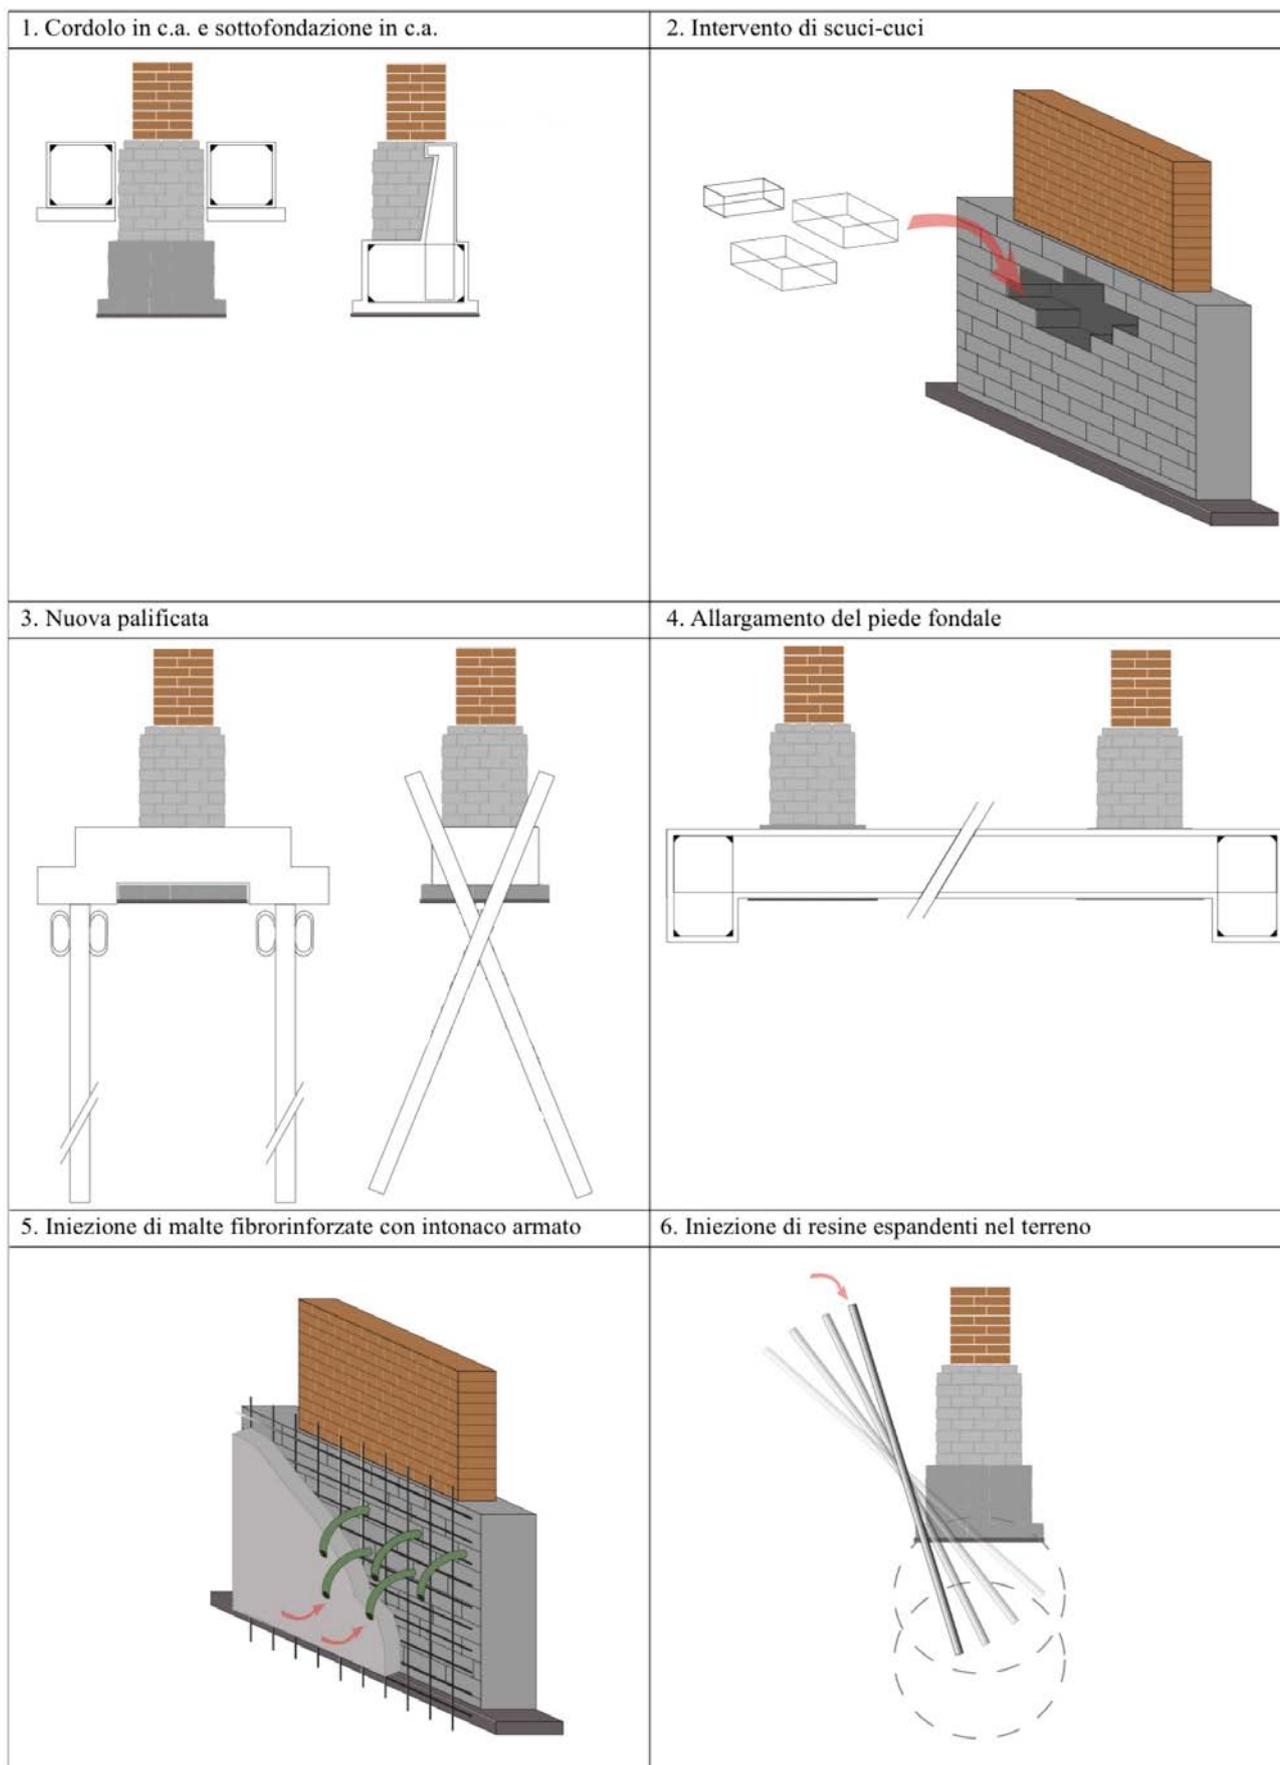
Schematizzazione di alcuni interventi eseguiti sulle fondazioni in muratura.
